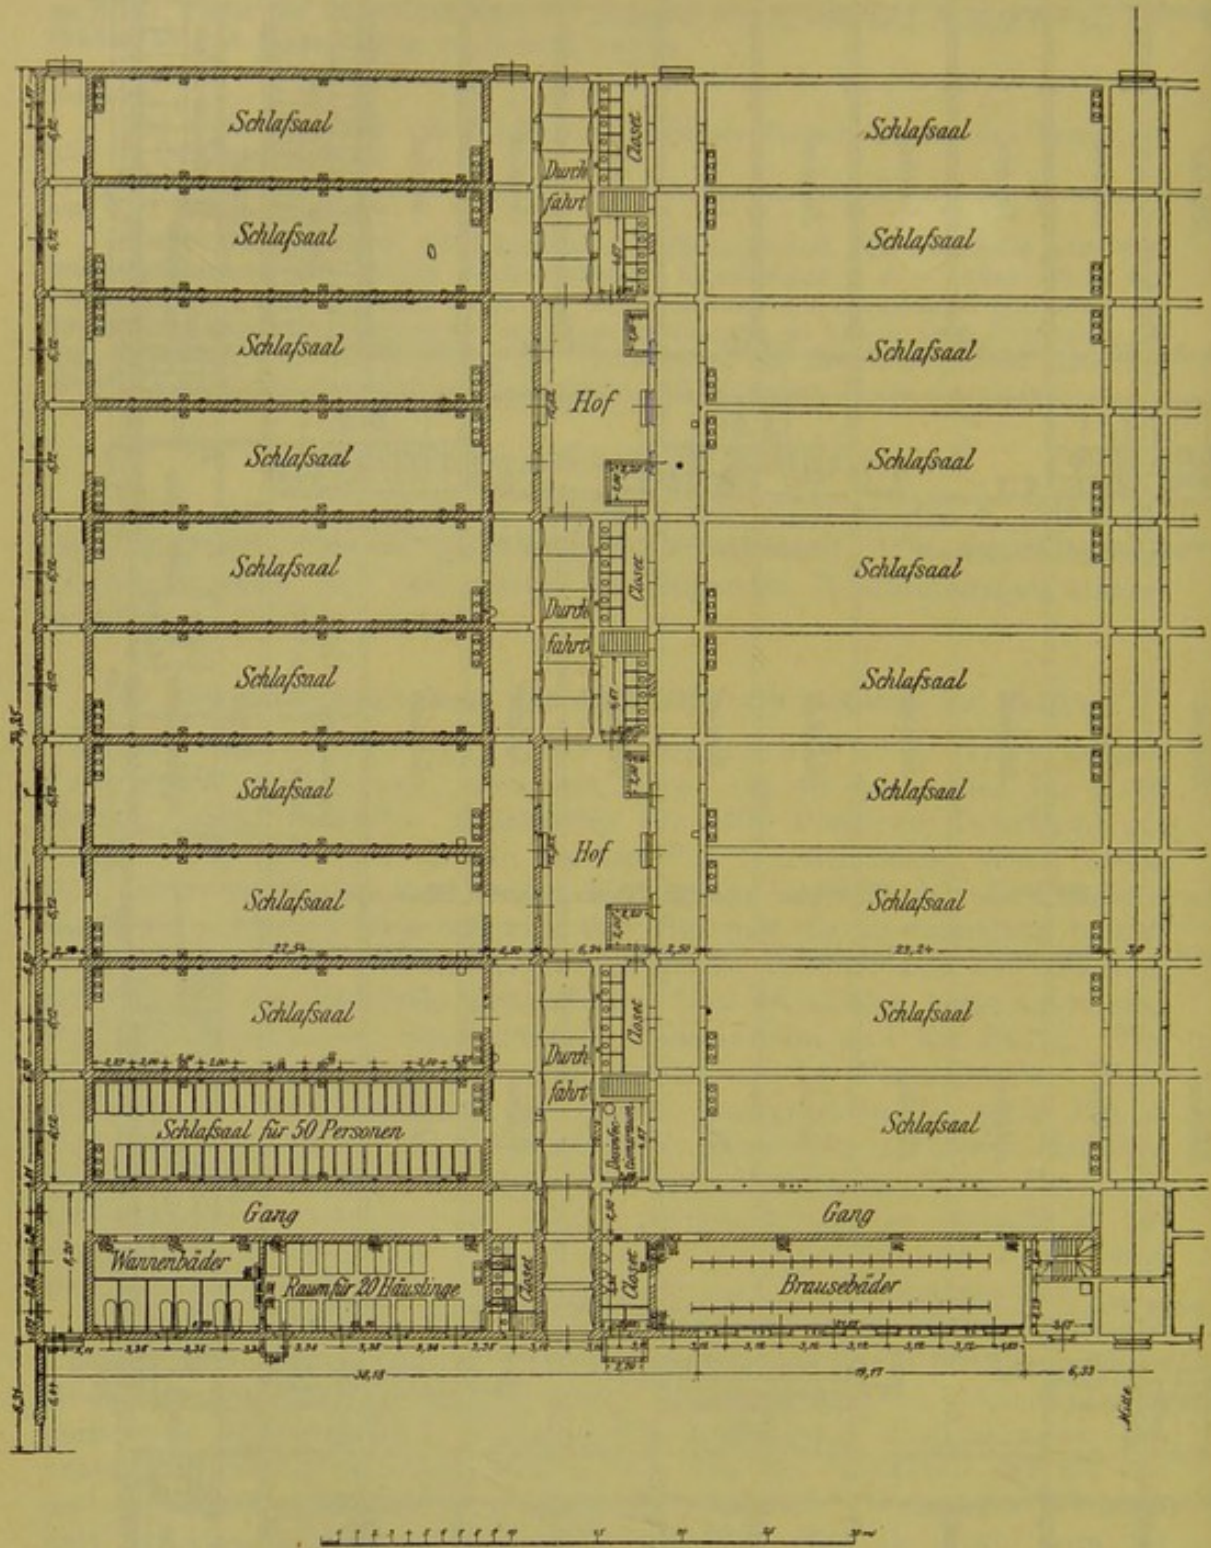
Städtisches Obdach für nächtliche Obdachlose zu Berlin. Grundriss. Ein Teil von Fig. 1 stärker vergrößert.
